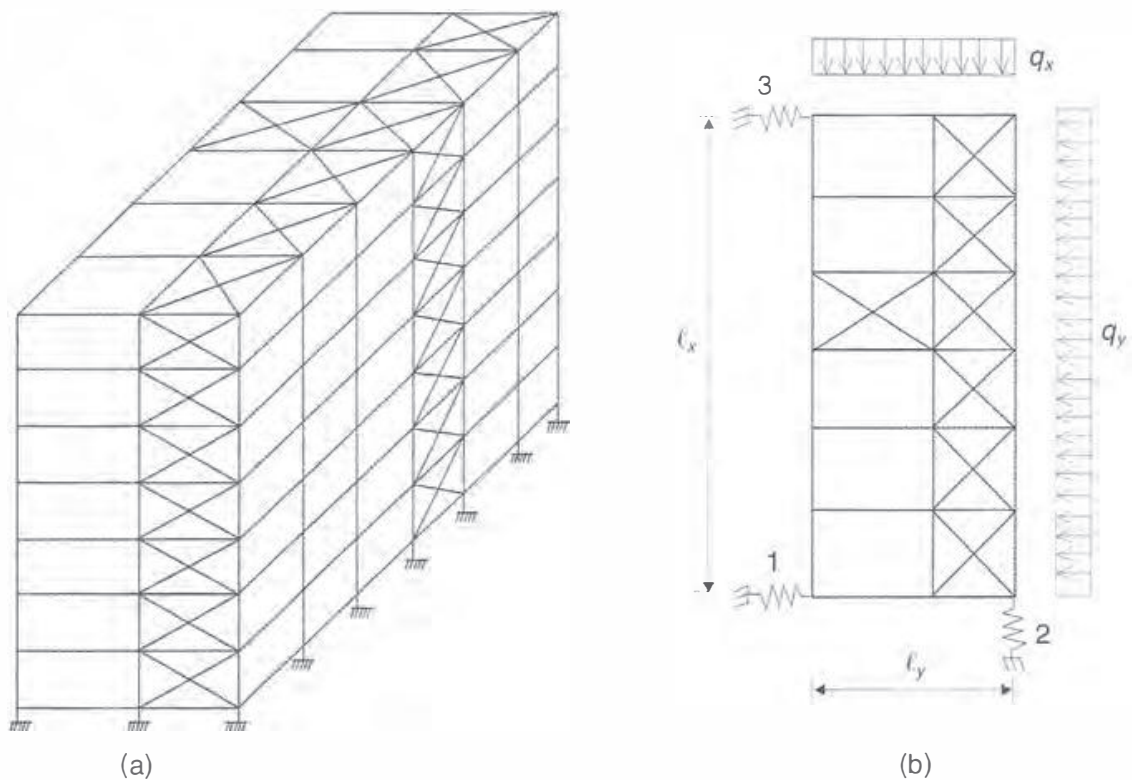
Edifício com contraventamentos treliçados: (a) esquema estrutural tridimensional; (b) planta do andar-tipo.
